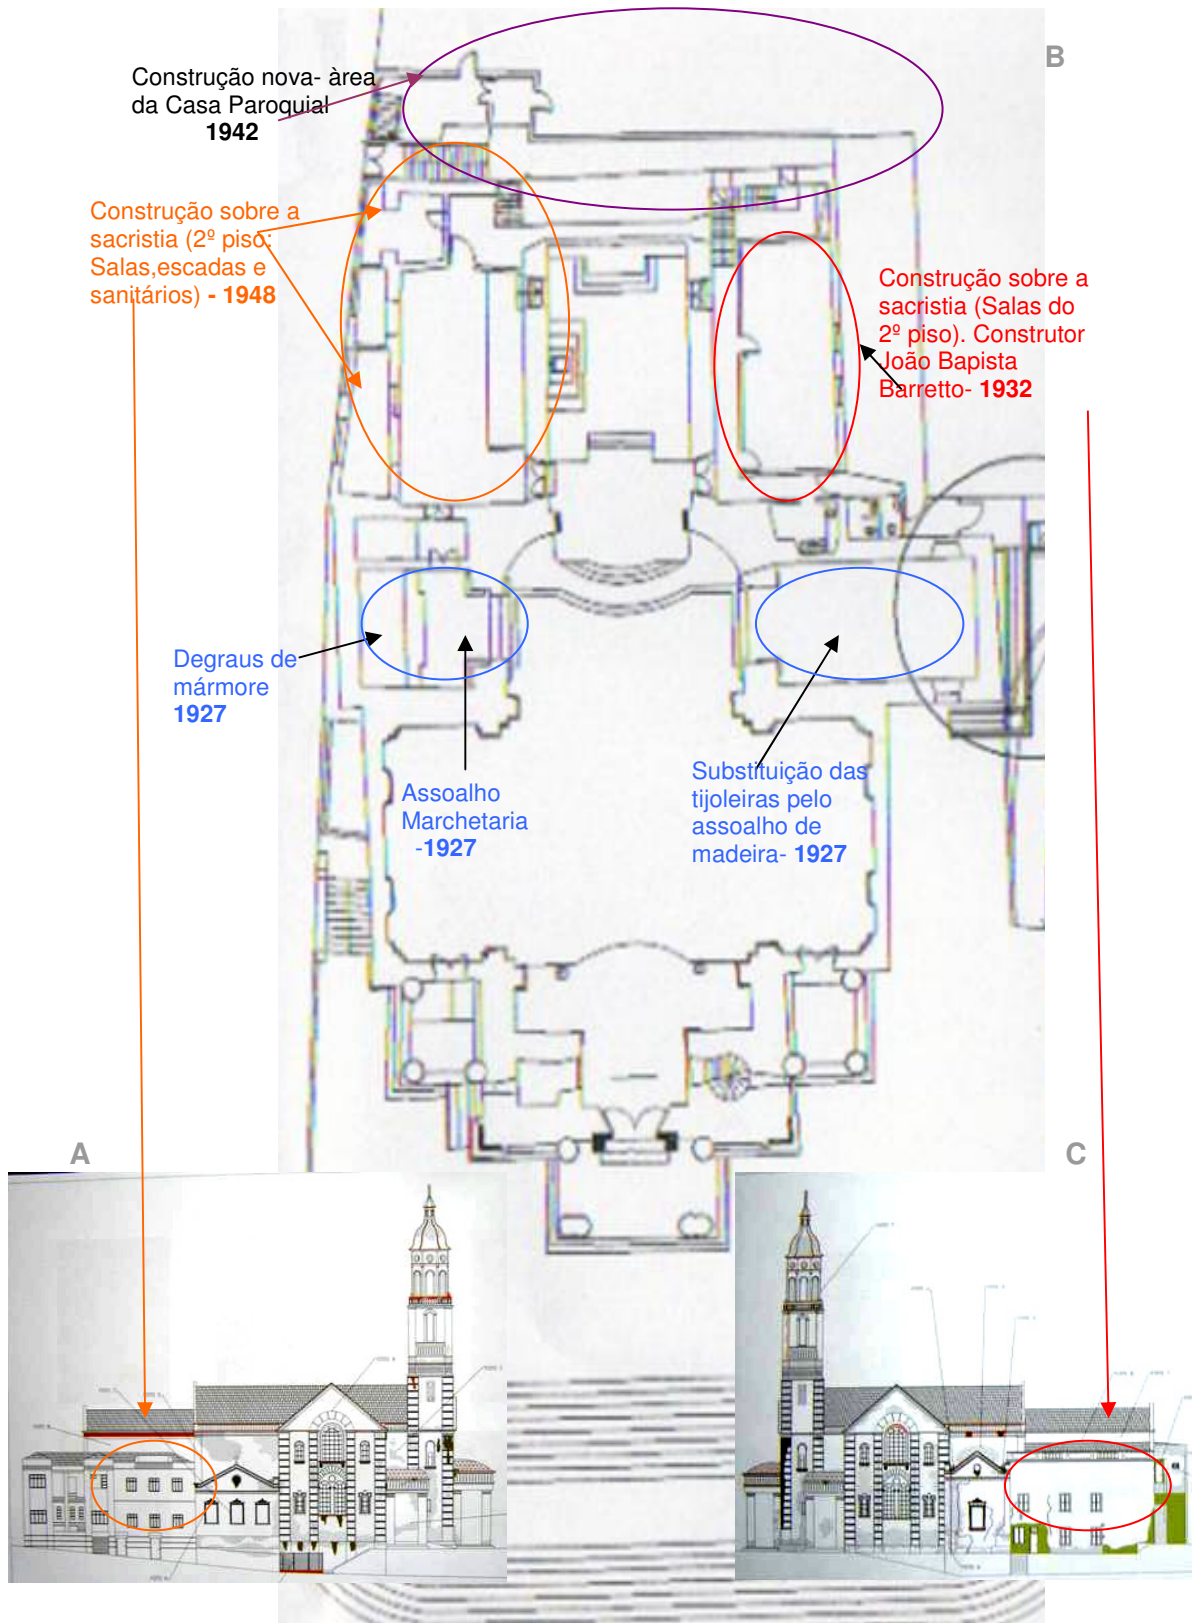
conjunto de plantas da Catedral indicando os anexos acoplados a edificação.
